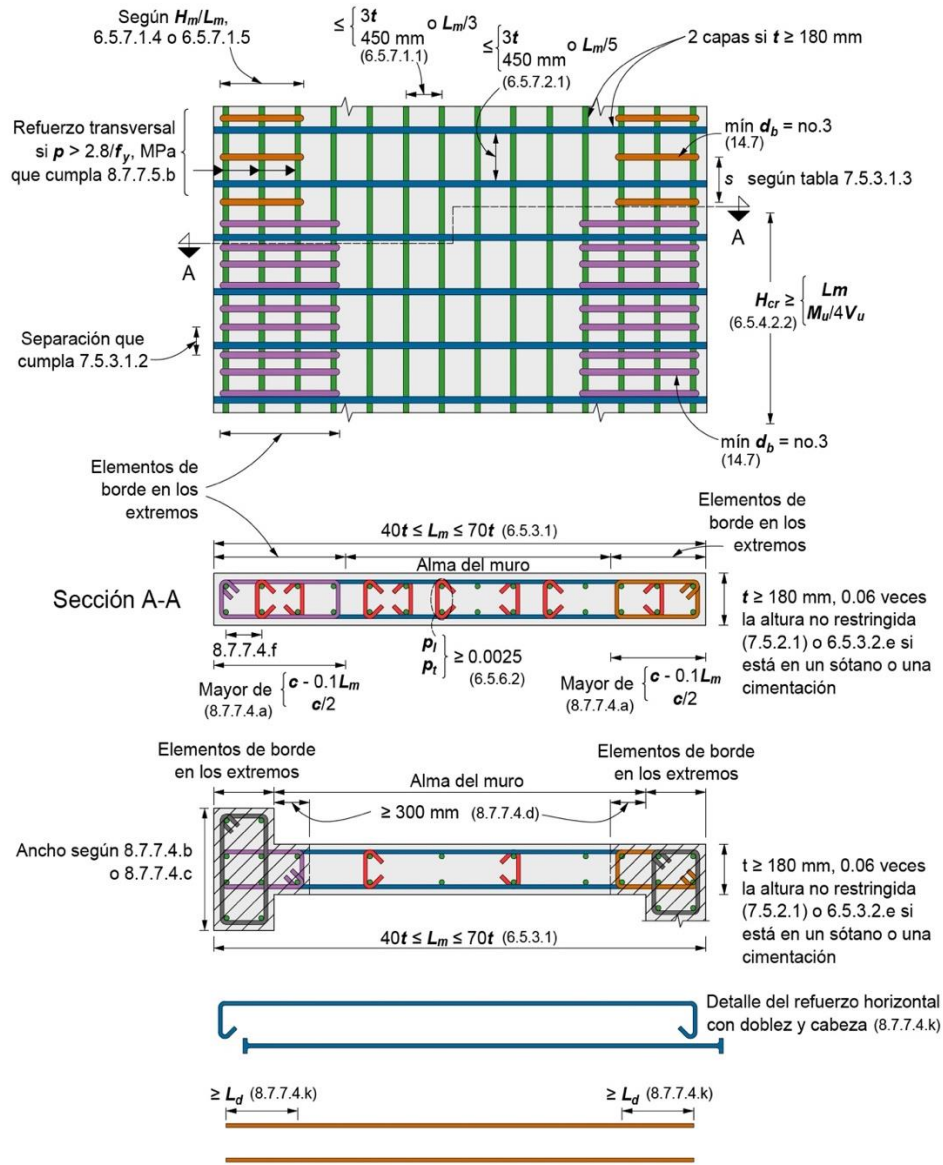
Detallado de muros de ductilidad media
